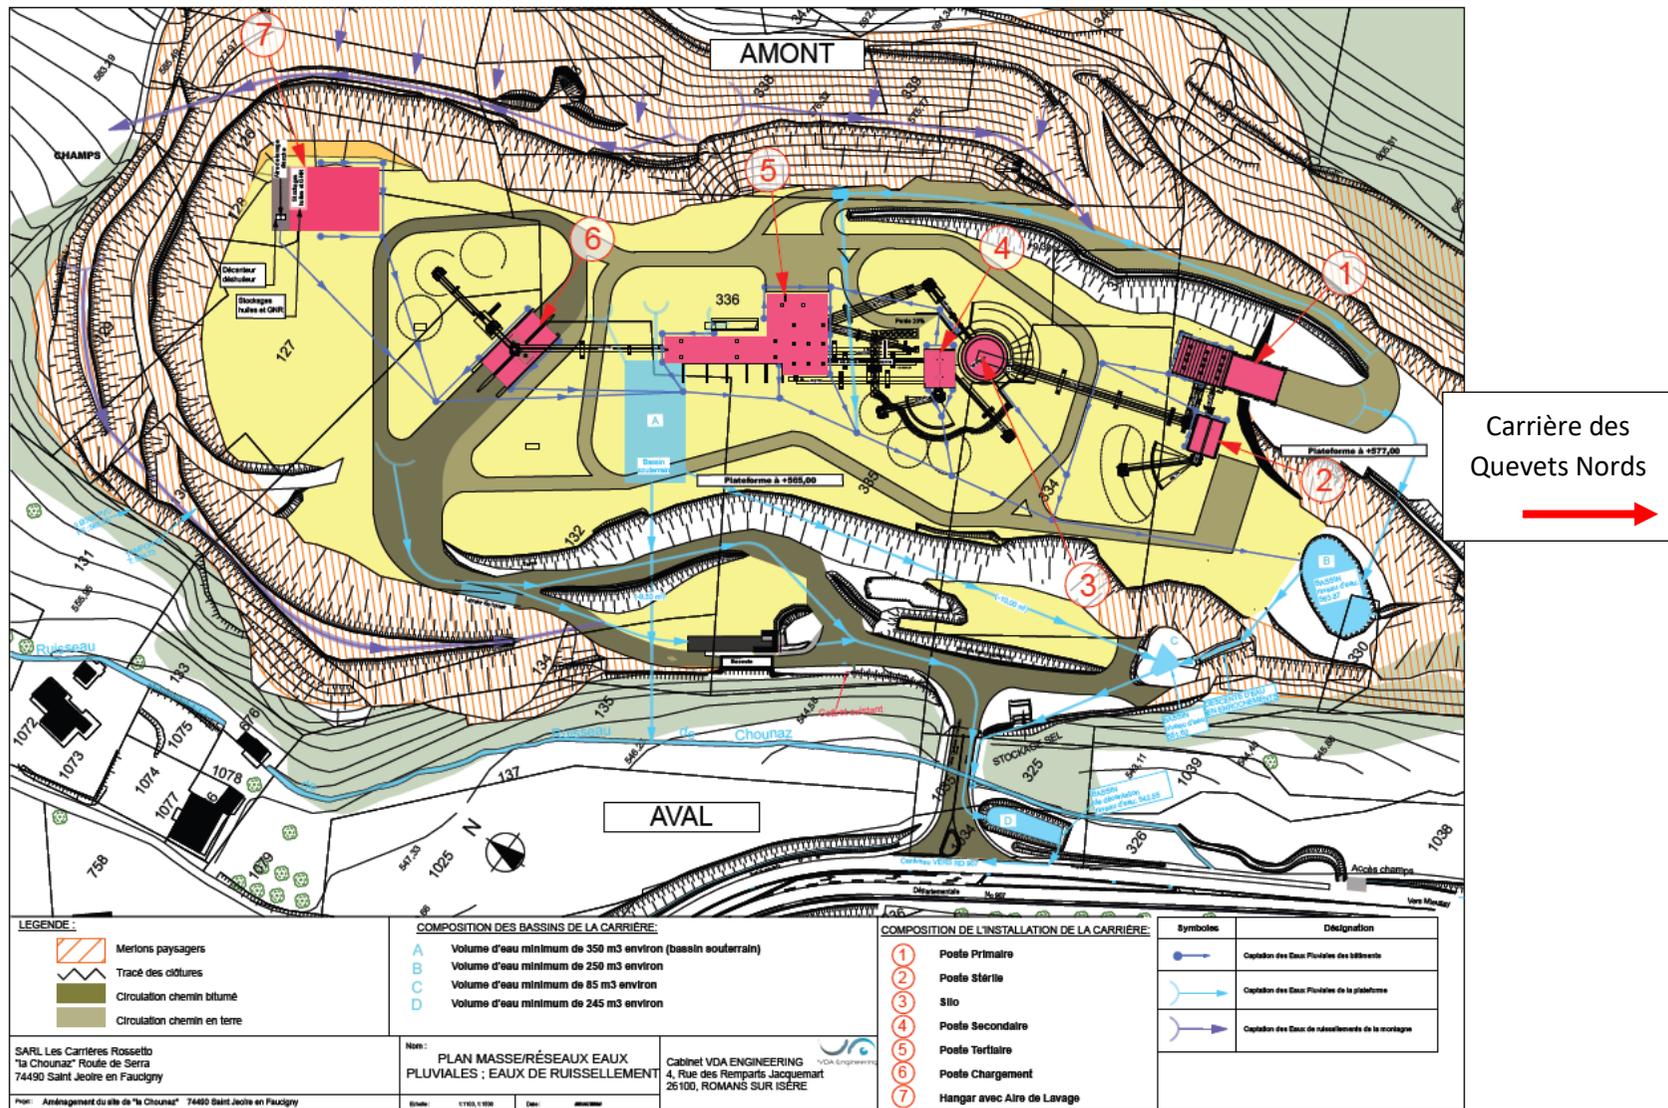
Plan de principe de gestion des eaux pluviales du site
